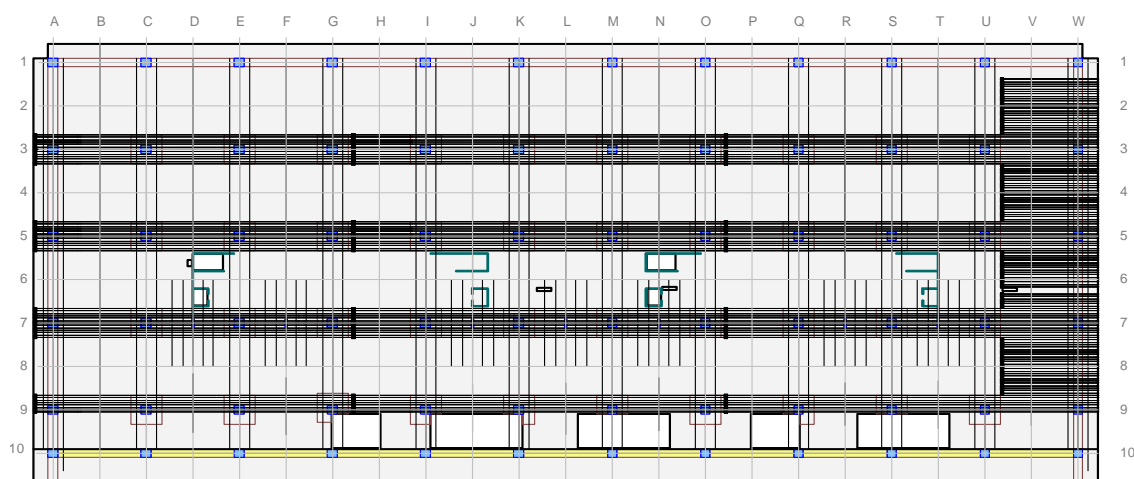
Planta pretensado dirección X – Estadios 2 y 3
